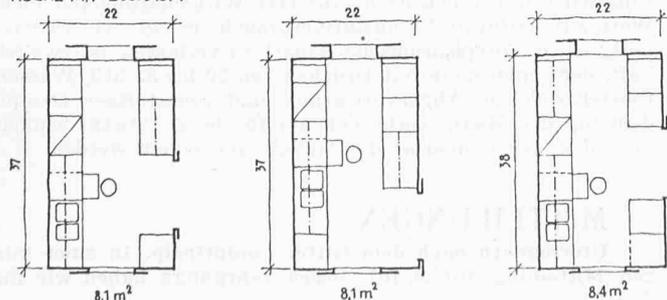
Anwendung des Standardvorschlages auf einige Küchengrundrisse
